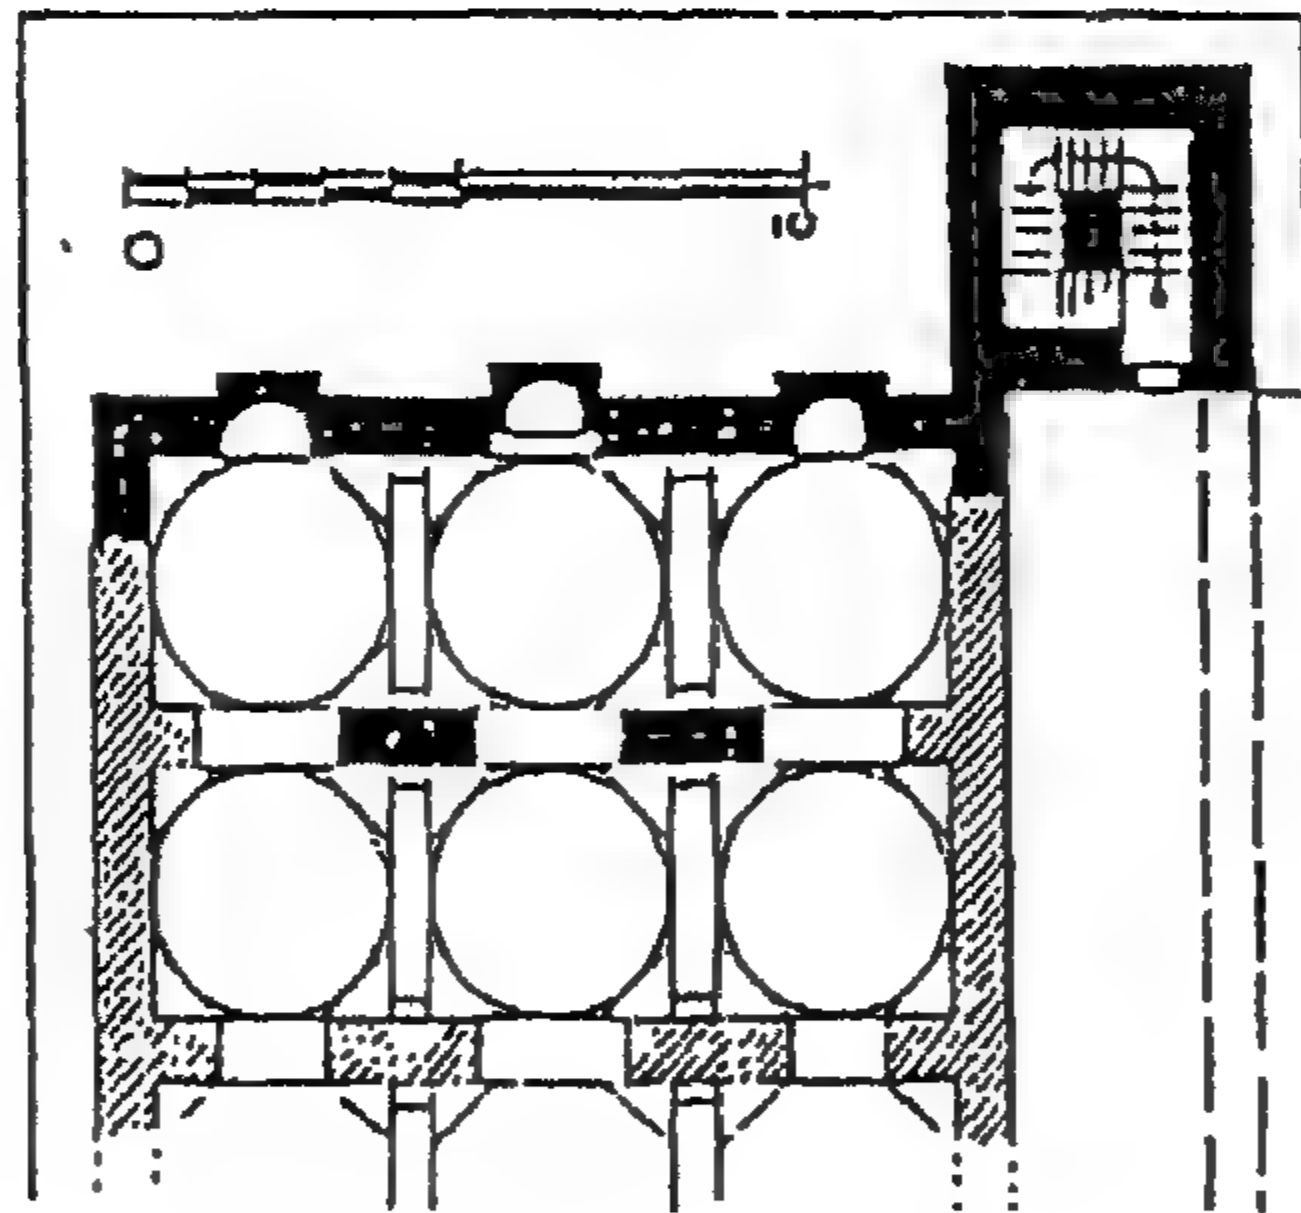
مسقط أفقي لمشهد آل طباطبا بعين الصيرة جنوب القاهرة
